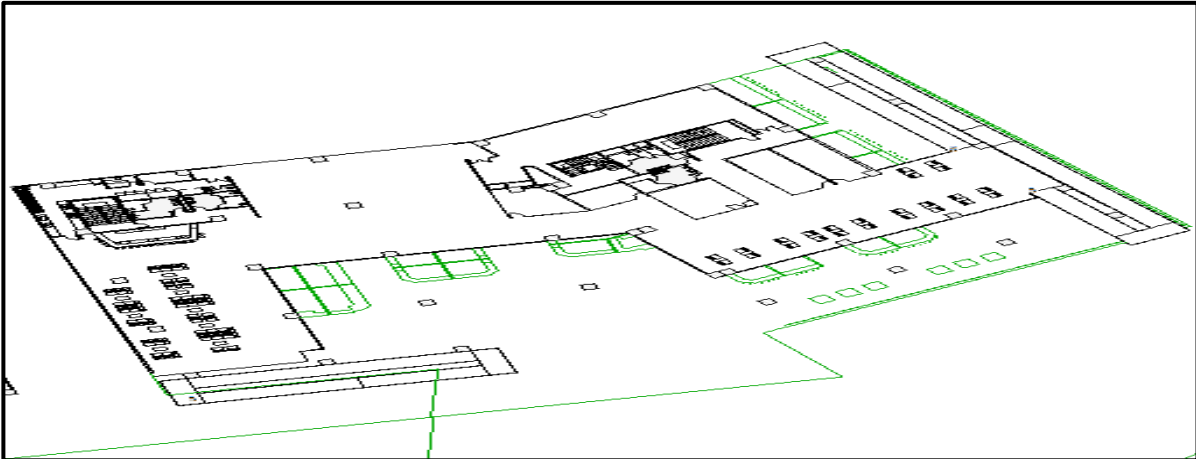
Centro de Gastronomía Local Planta 2. *El Autor. (2017).
